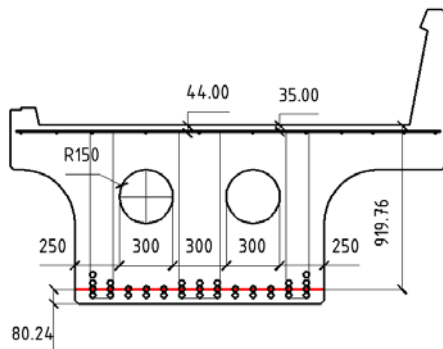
Плитна прогонова будова з поздовжніми круглими отворами. Розташування арматури. Варіант № 2
